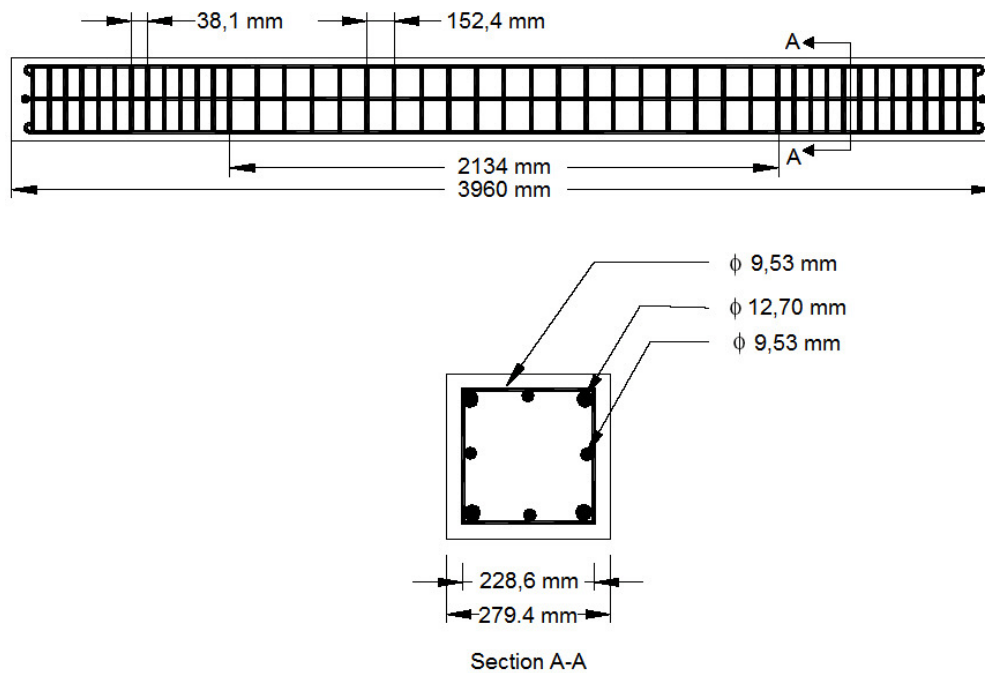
Detalhamento das vigas ensaiadas por Panchacharam e Belarbi (2002).
